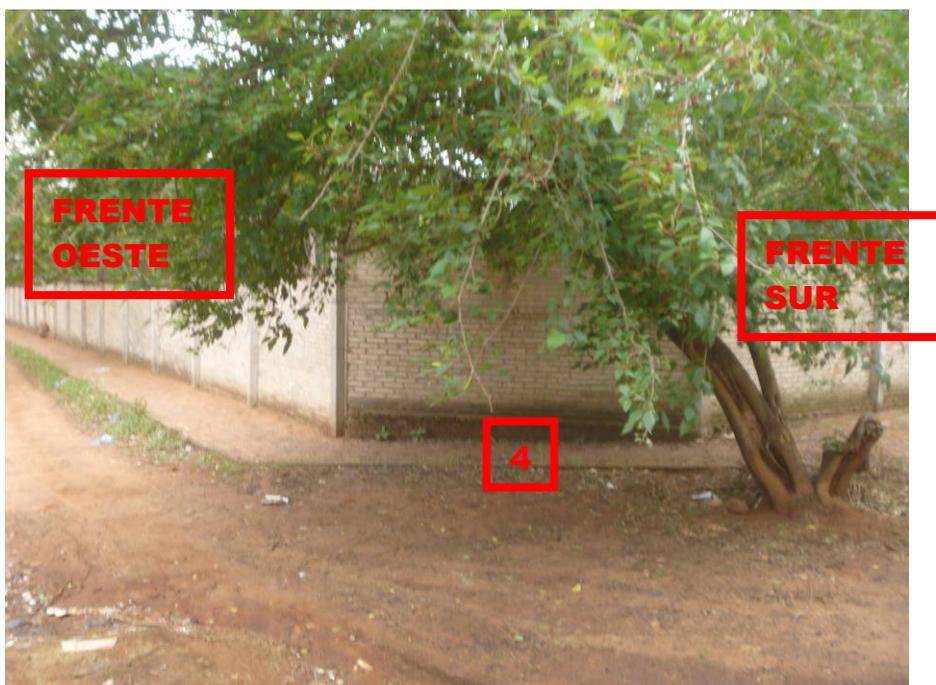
Vista General de la propiedad desde la esquina de las calles José Cataldi y Andrés Salomón (se observan el vértice 4, la muralla de ladrillos comunes con pilares de hormigón armado, la ochava, la vereda y el pavimento terraplenado/empedrado)
